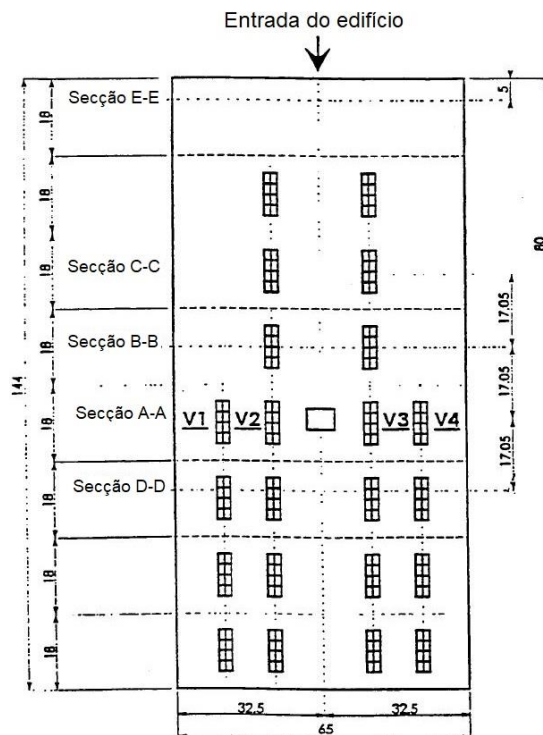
Planta e localização dos cortes do edifício "Parc des expositions" em Paris (adaptado de [17])
